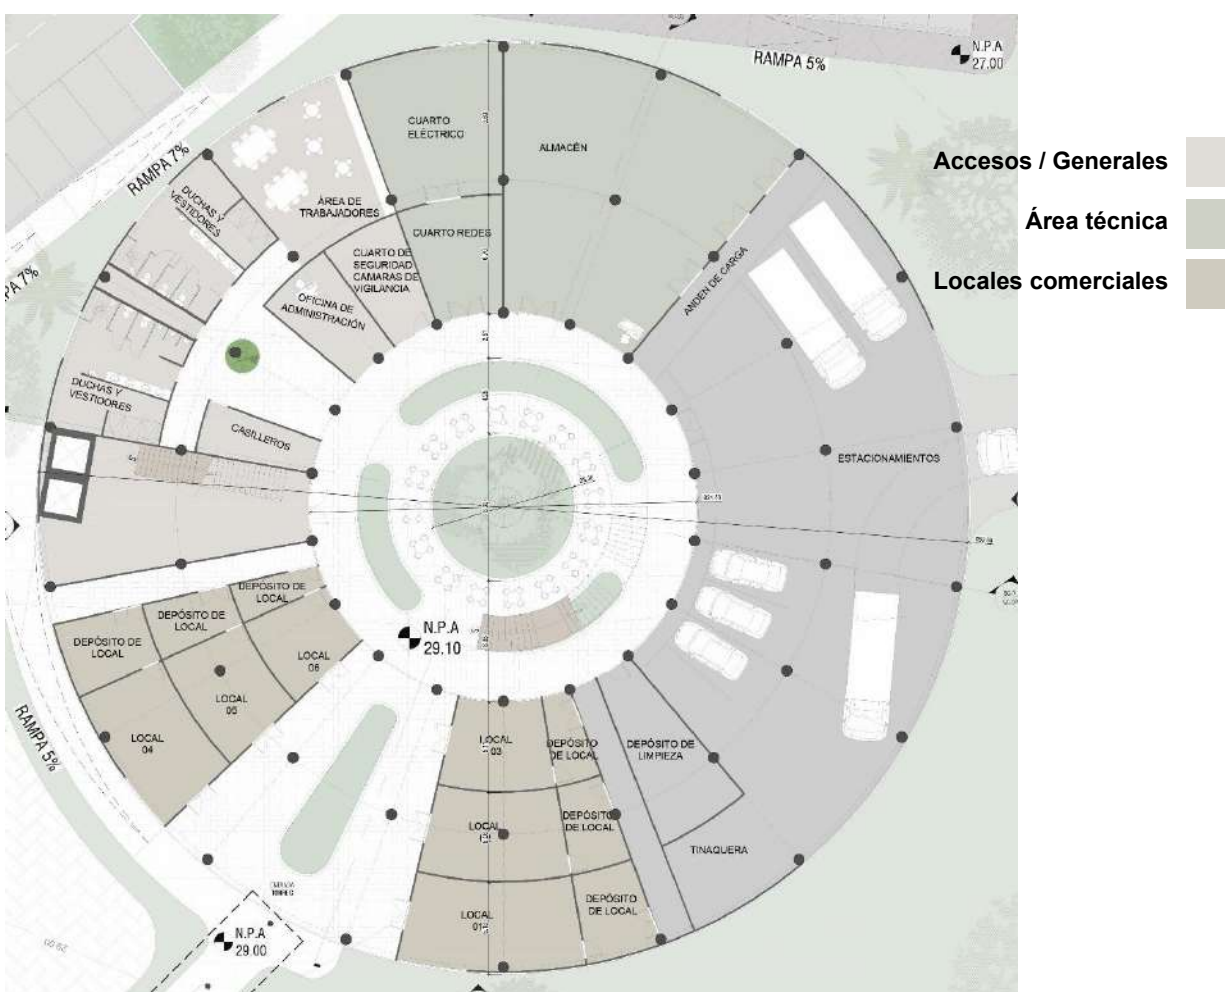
Ampliación de la planta baja de la torre C. Fuente: elaboración propia 2025
